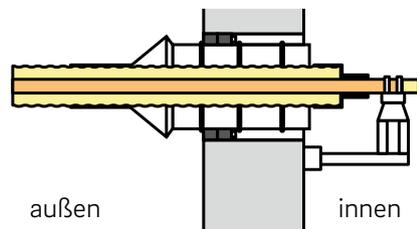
Einbauschema Hauseinführungsset mit Schrumpfschlauch und Gliederkettendichtung
